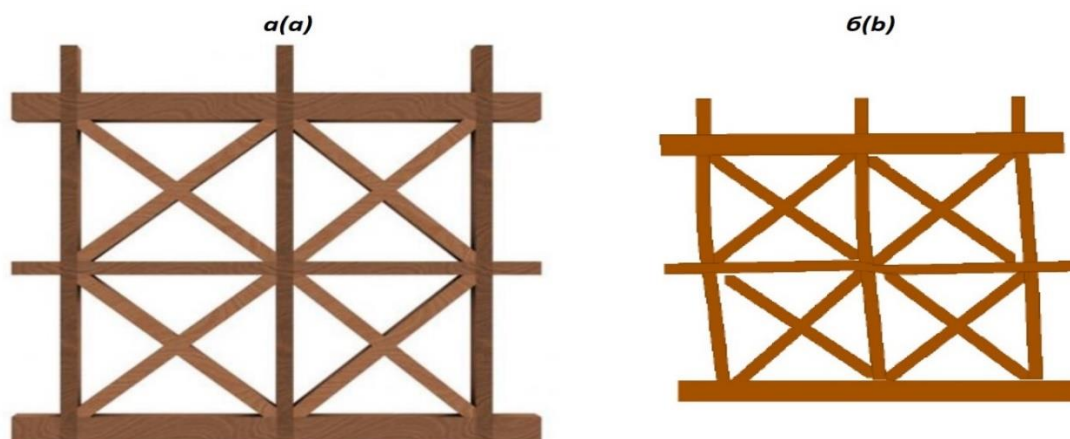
Деревянная рама стены в конструктивной системе «Помбалино»: а – до испытаний; б – поведение стены во время испытаний
